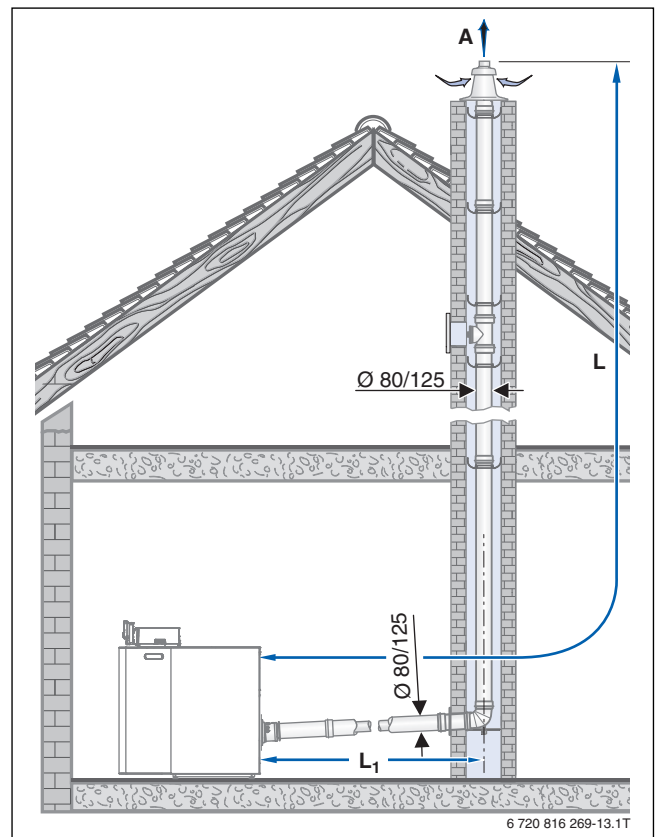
Guía vertical de tubo concéntrico en la chimenea (C_{33(x)})
